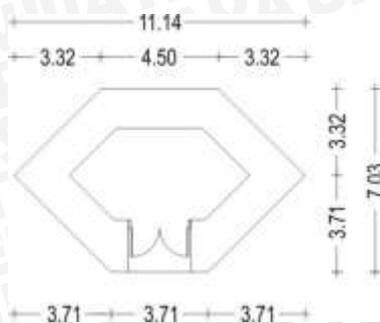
Site plan menara Masjid Jamik Sumenep
